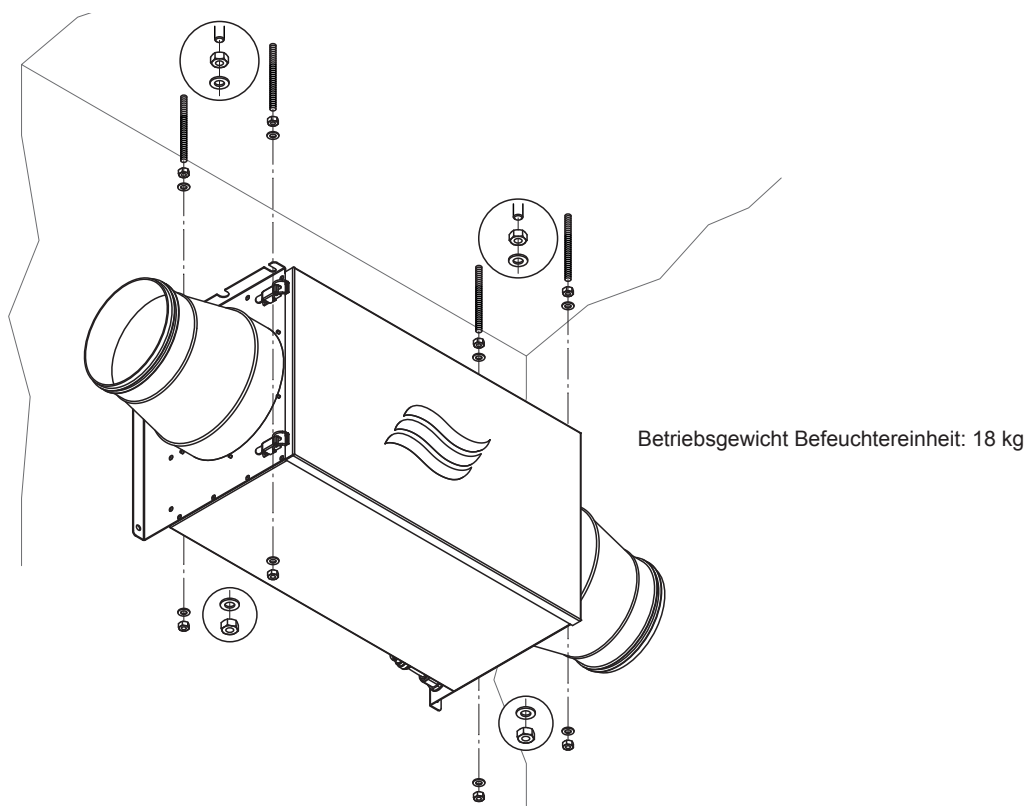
Befeuchtergehäuse an den Gewindestangen befestigen
